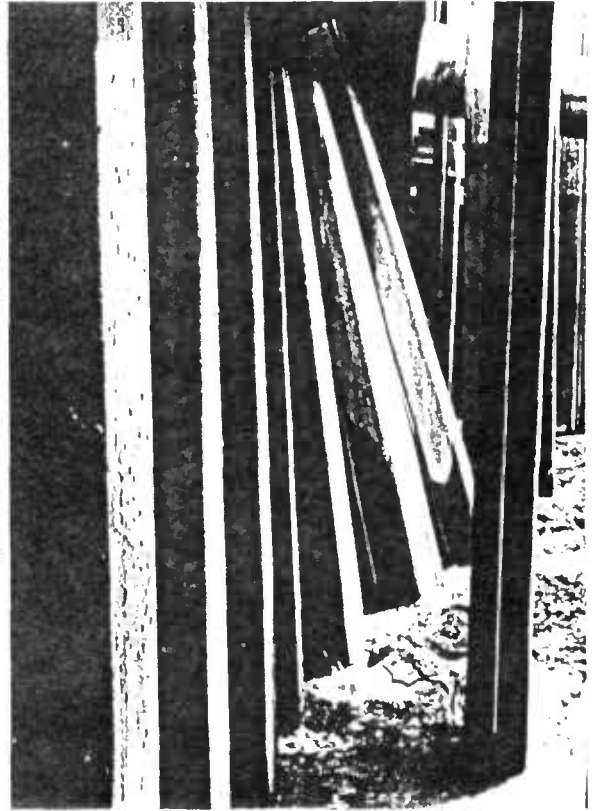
Déversement d'un batardeau à la suite d'un renard hydraulique.
